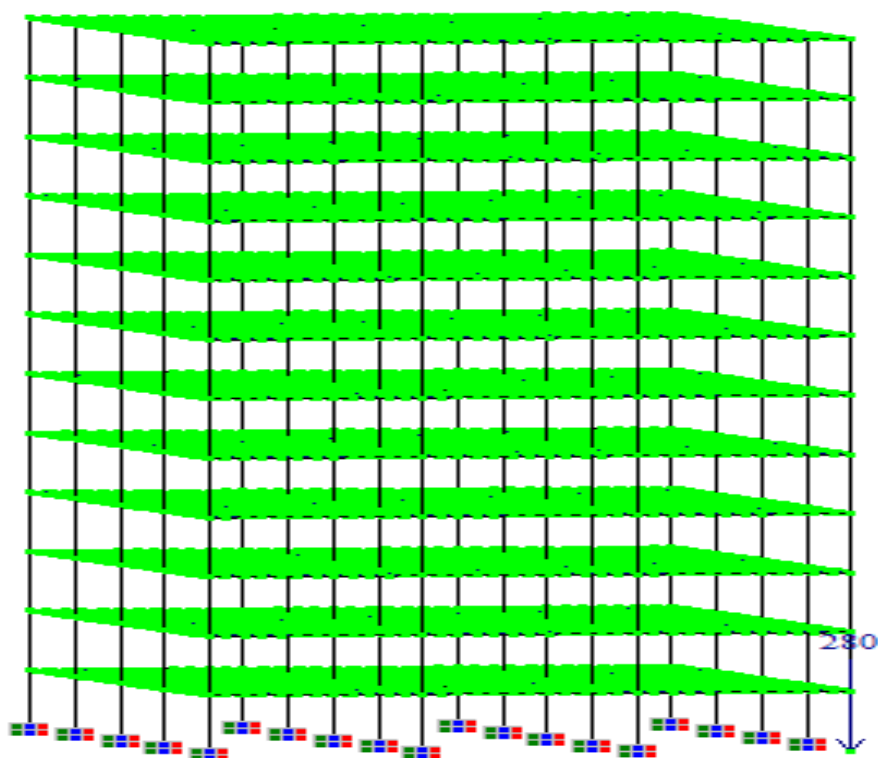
Schéma illustratif du modèle d'étude du bâtiment avec planchers en hourdis à 12 niveaux avec un chargement vertical sur le poteau d'angle
